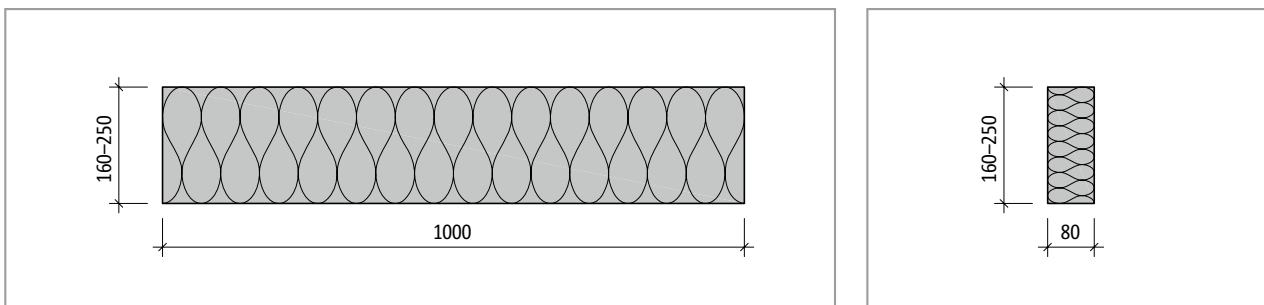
Schöck Isokorb® T tipo Z-EI0: Vista y sección del producto
